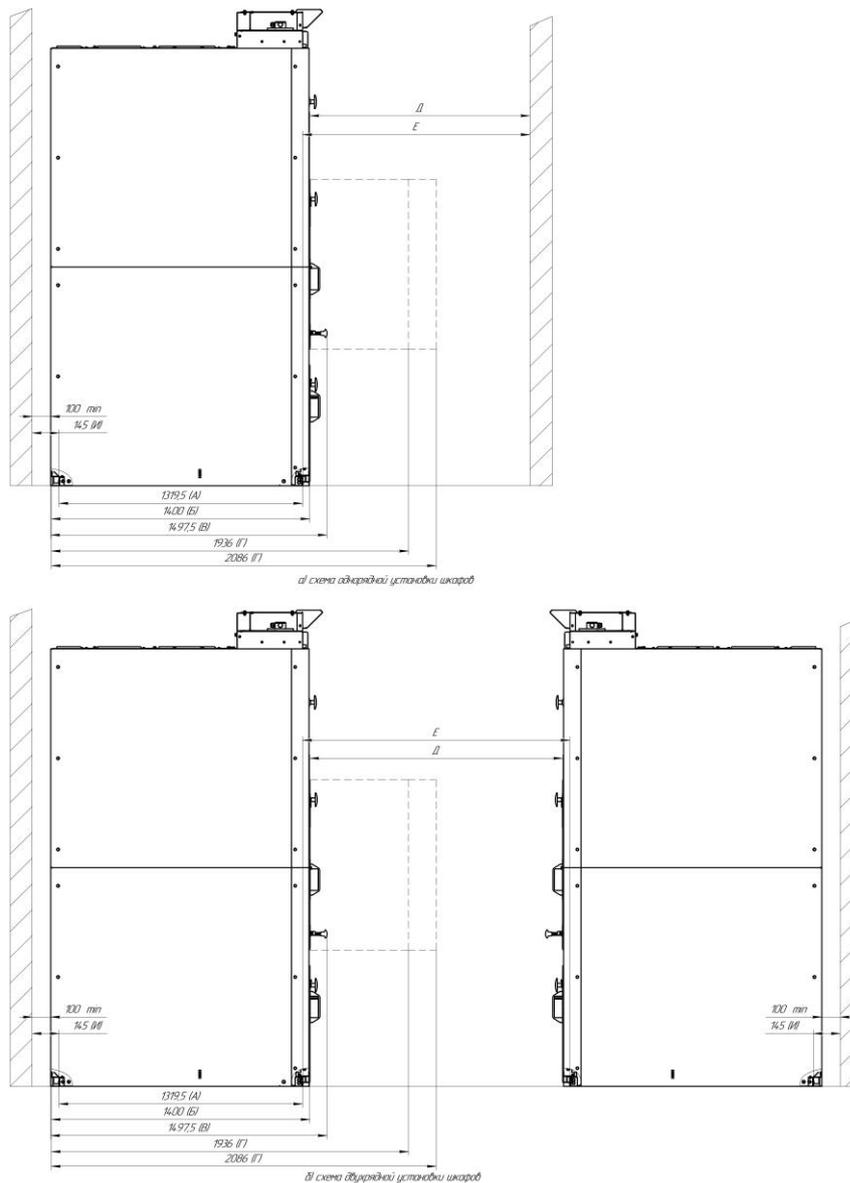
Габаритные размеры шкафов и коридоров обслуживания
